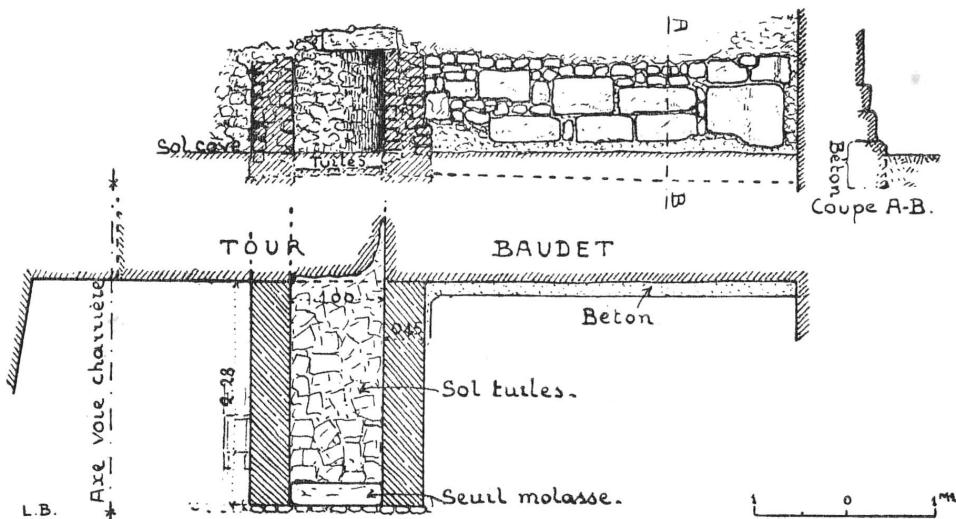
Plan et élévation du mur et de la porte romaine.
